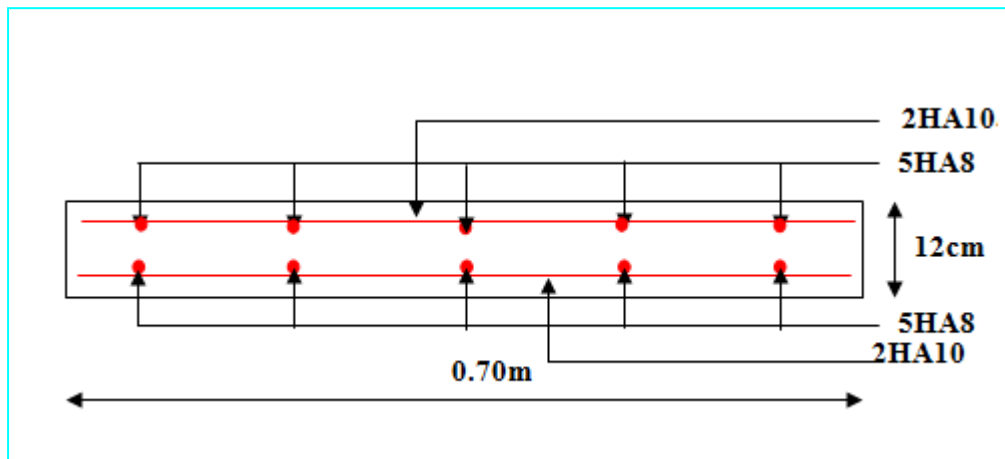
Schémas de ferrailage de dalle pleine (type 02)
